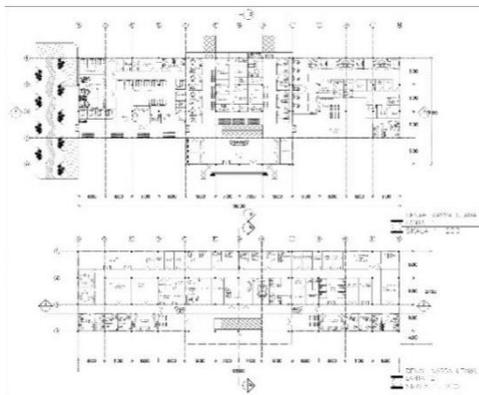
Aplikasi Bentuk dan Tampilan
